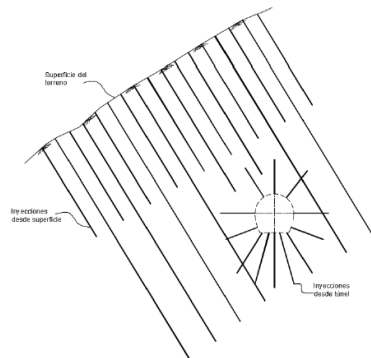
Intersección de cortinas desde superficie y desde túneles. Adaptado de "Construction and design of cement grouting" de Hously, A.C. (1990).
